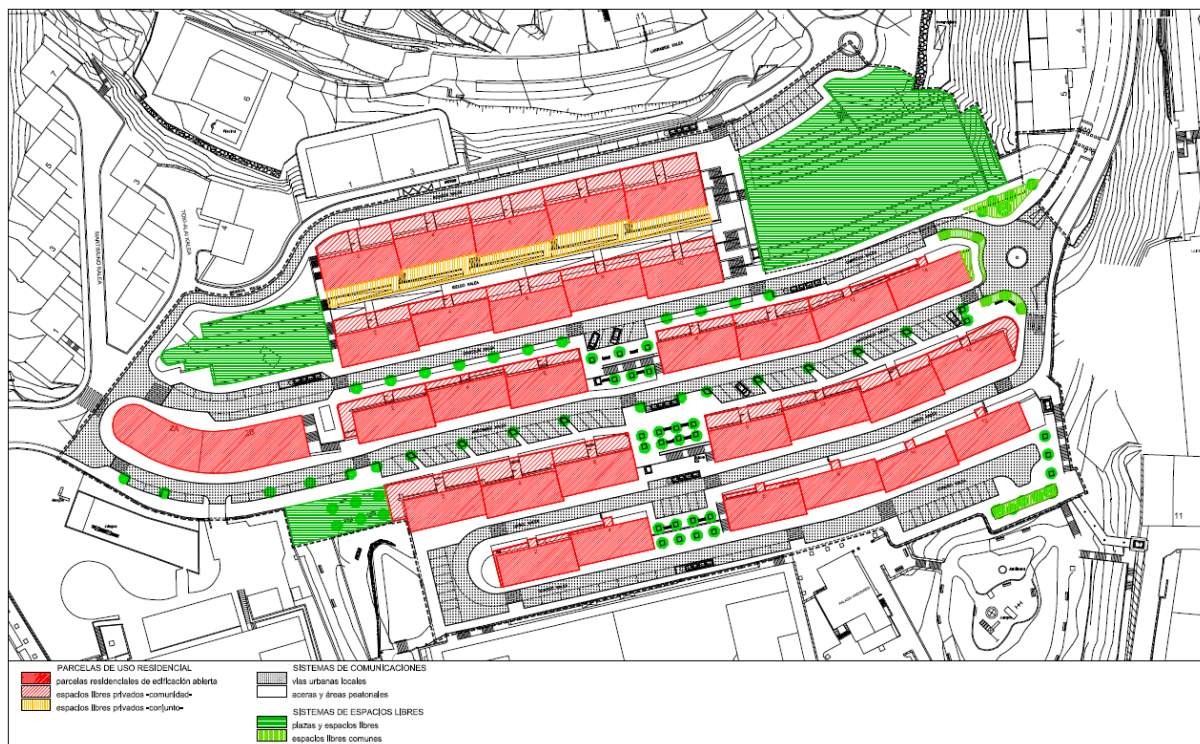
Ordenación pormenorizada del barrio de Andonaegi. Fuente: Plano PRO.11-1 del Plan Especial
